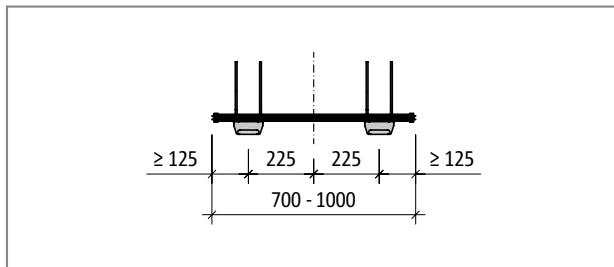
Schöck Tronsole® Typ T-V2-H...-L700 bis L1000: Produktgrundriss
